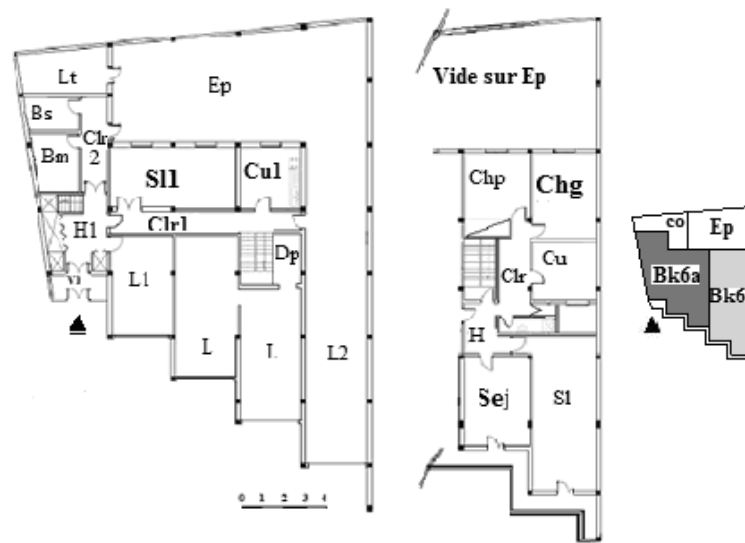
Plan rez-de-chaussée et étage de l'habitation Bk6b
